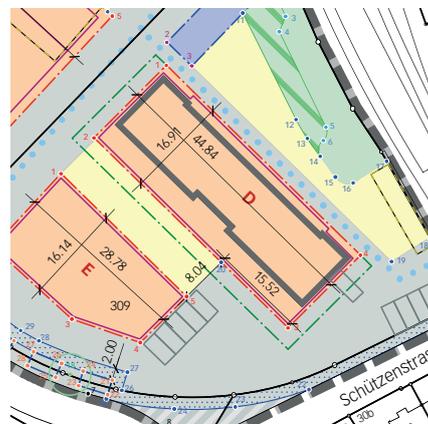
Die Baulinie für vorspringende Gebäudeteile 2.5 m (im Plan dunkelgrün dargestellt).
